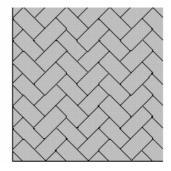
Configuração do pavimento com blocos intertravados do tipo "espinha de peixe" (fonte: Hallack)
